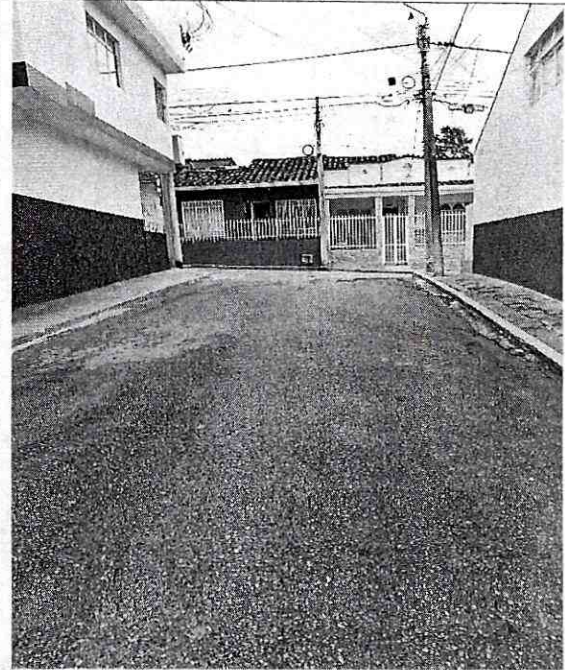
las Franjas de circulación se encuentran en concreto y en tableta roja tipo exterior.
